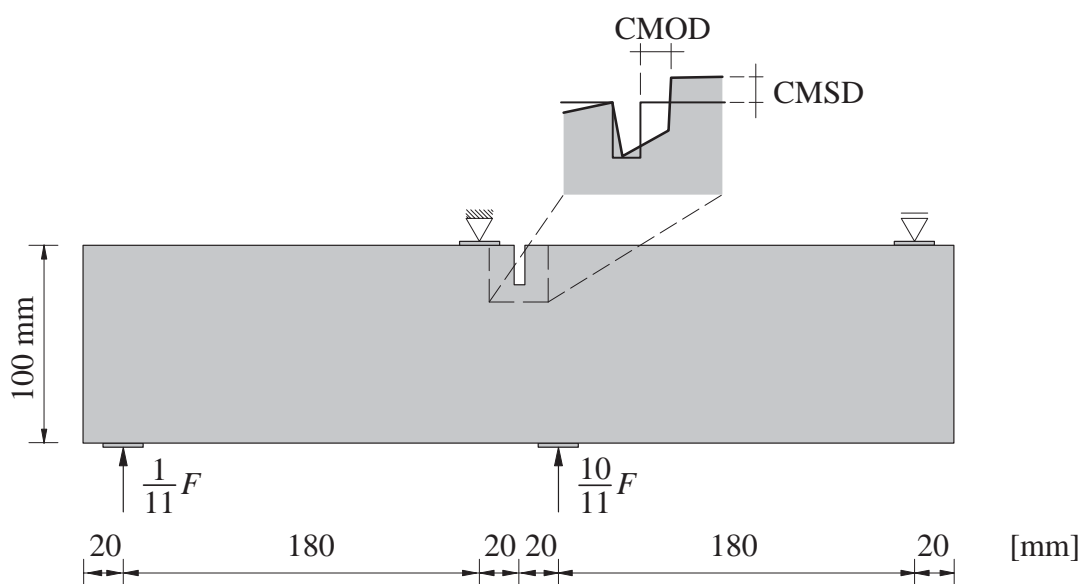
Vierpunkt–Biegebalken: System und Beanspruchung
